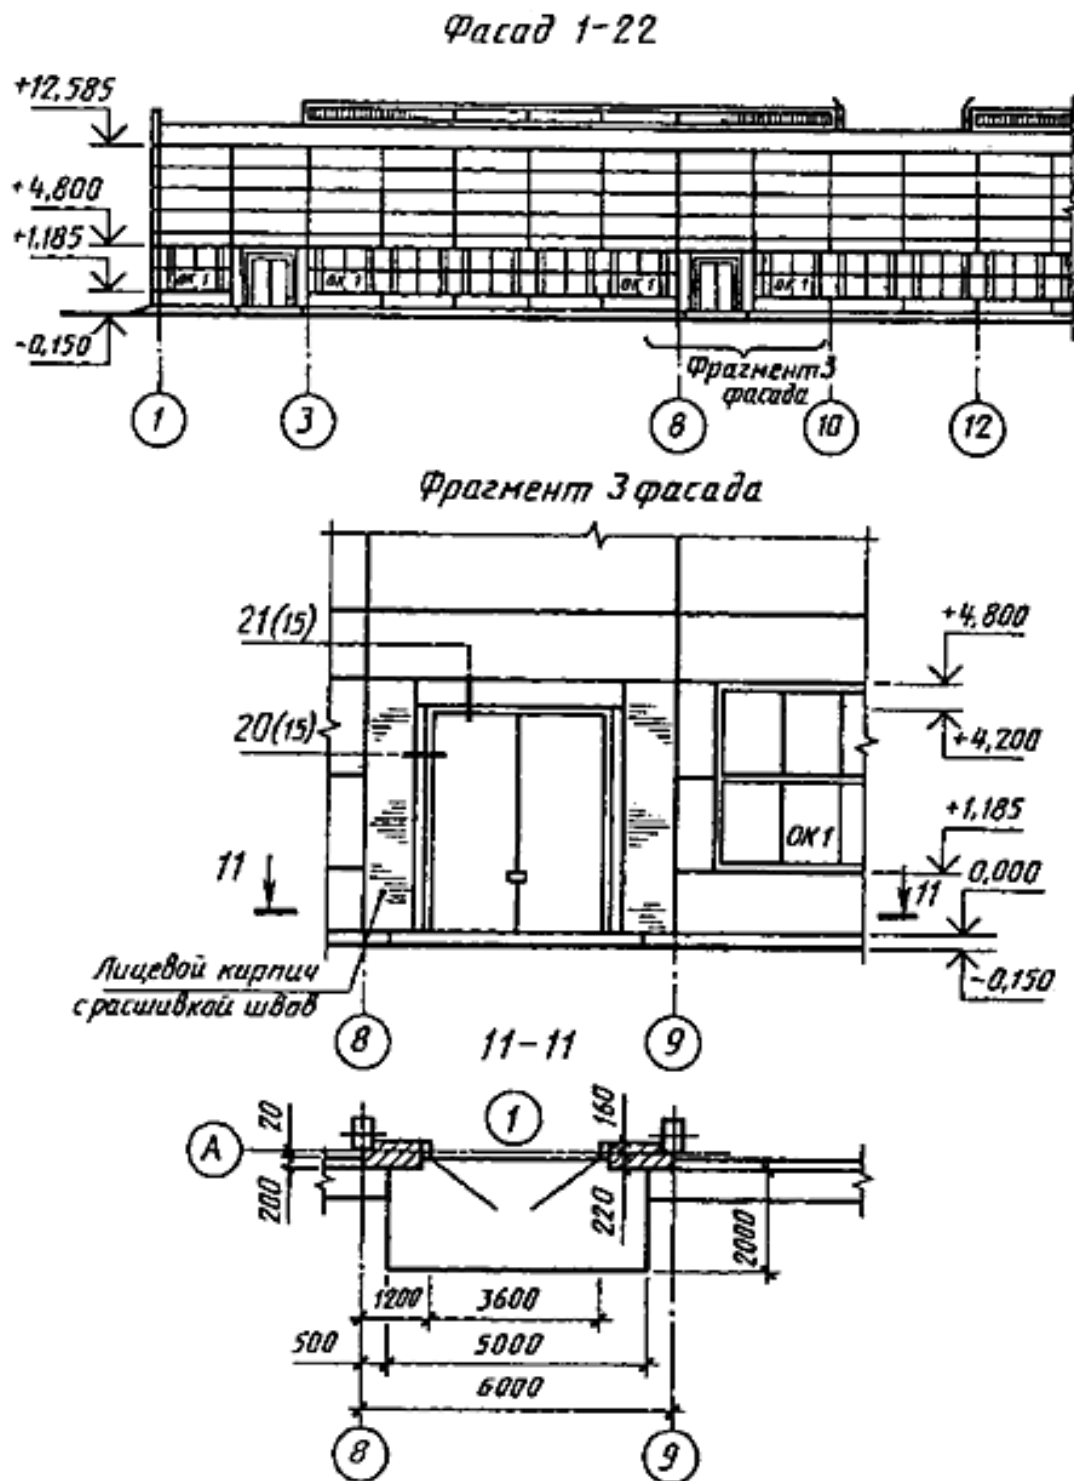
Пример выполнения фасада и фрагмента фасада здания
